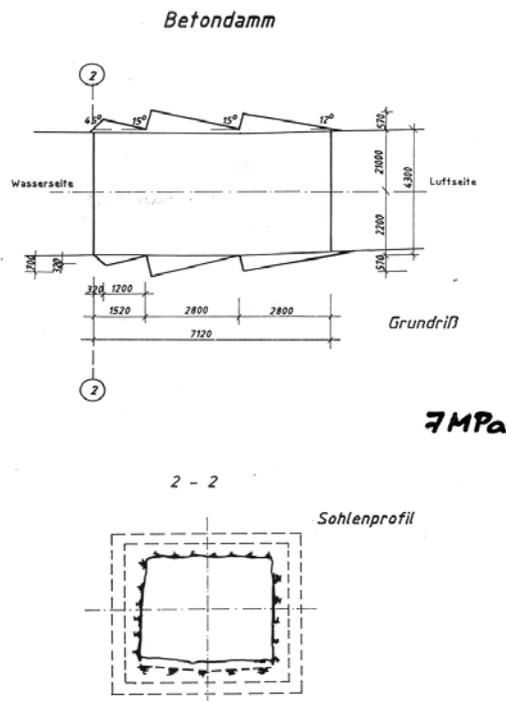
Darstellung der Dammkonstruktion (Material: Beton)
